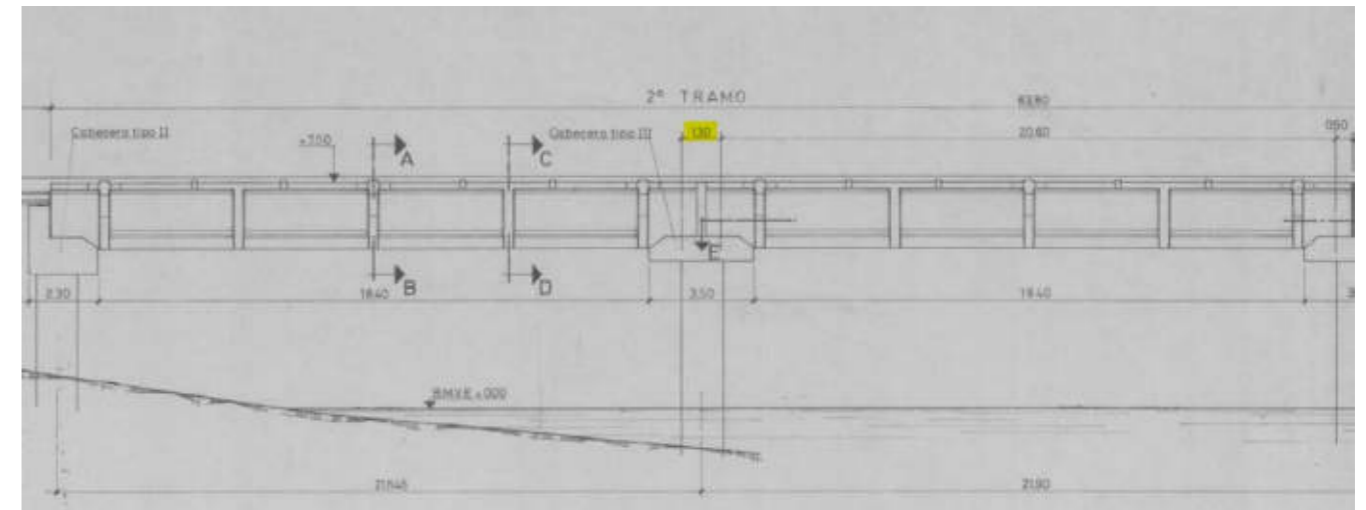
Geometría de los pilotes del tramo 2 de la pasarela de acceso (Fuente: planos del proyecto constructivo)
